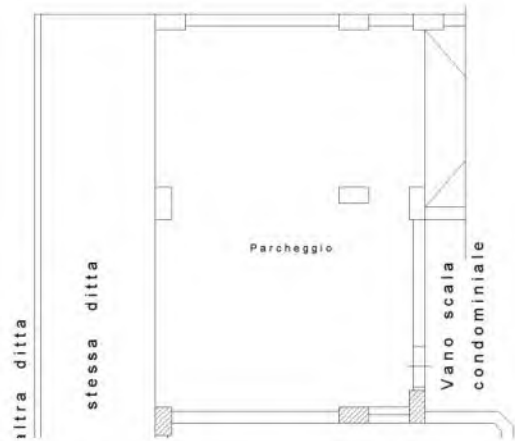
Planimetria Catastale fg. 18 part. 974 sub 15
